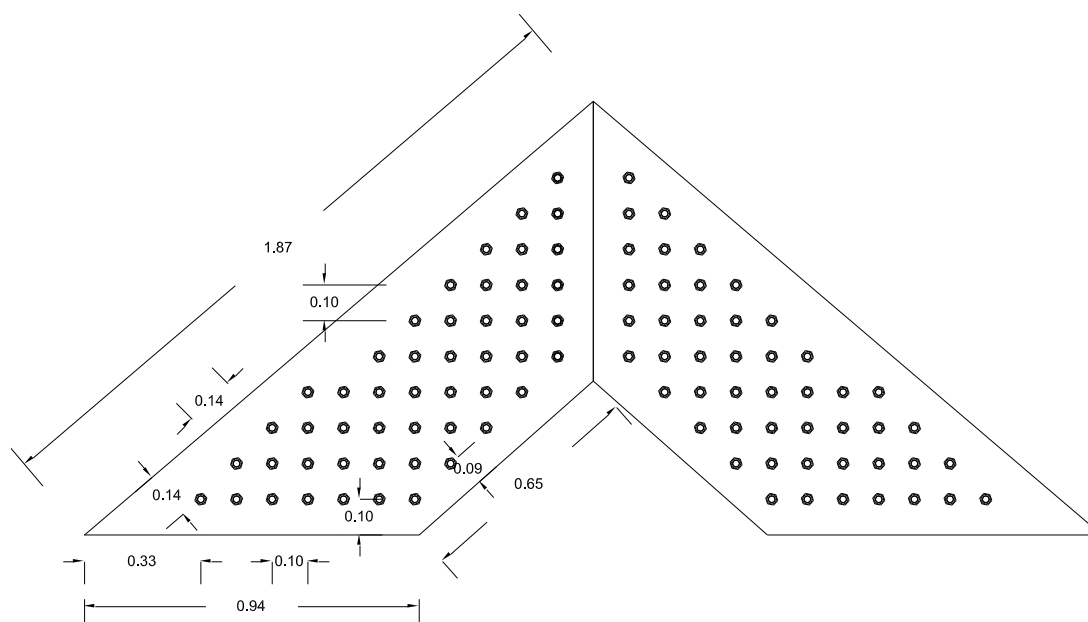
Geometria da chapa de ligação entre as diagonais as cordas da viga principal (unidades em [m])
